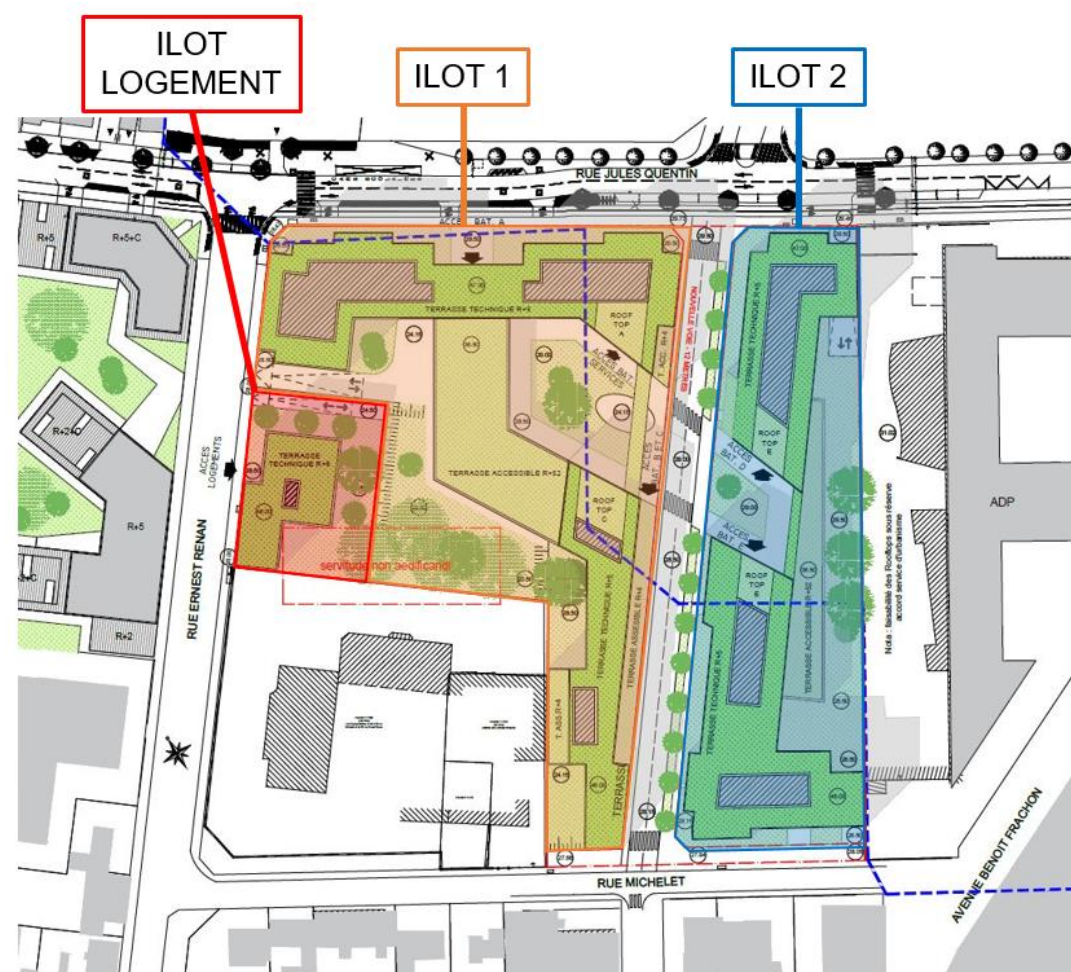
Plan masse du projet Vectorial (source : CALQ, avril 2020)
